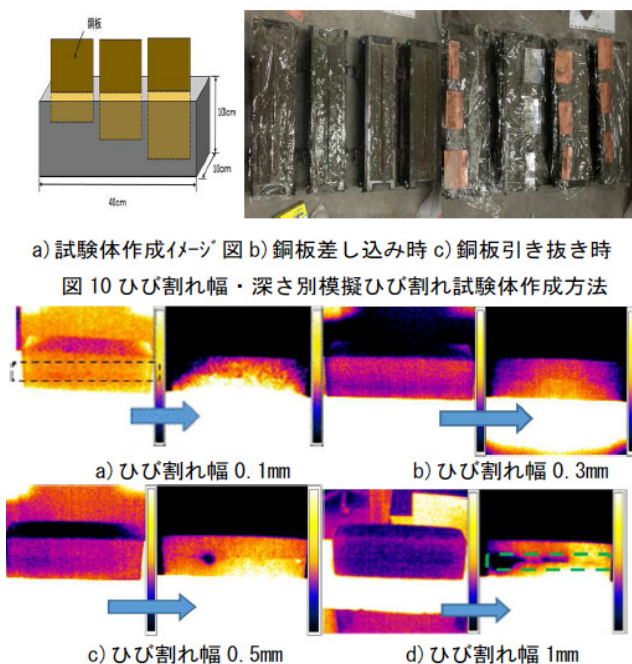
ひび割れ幅・深さ別模擬ひび割れ試験体赤外線画像
